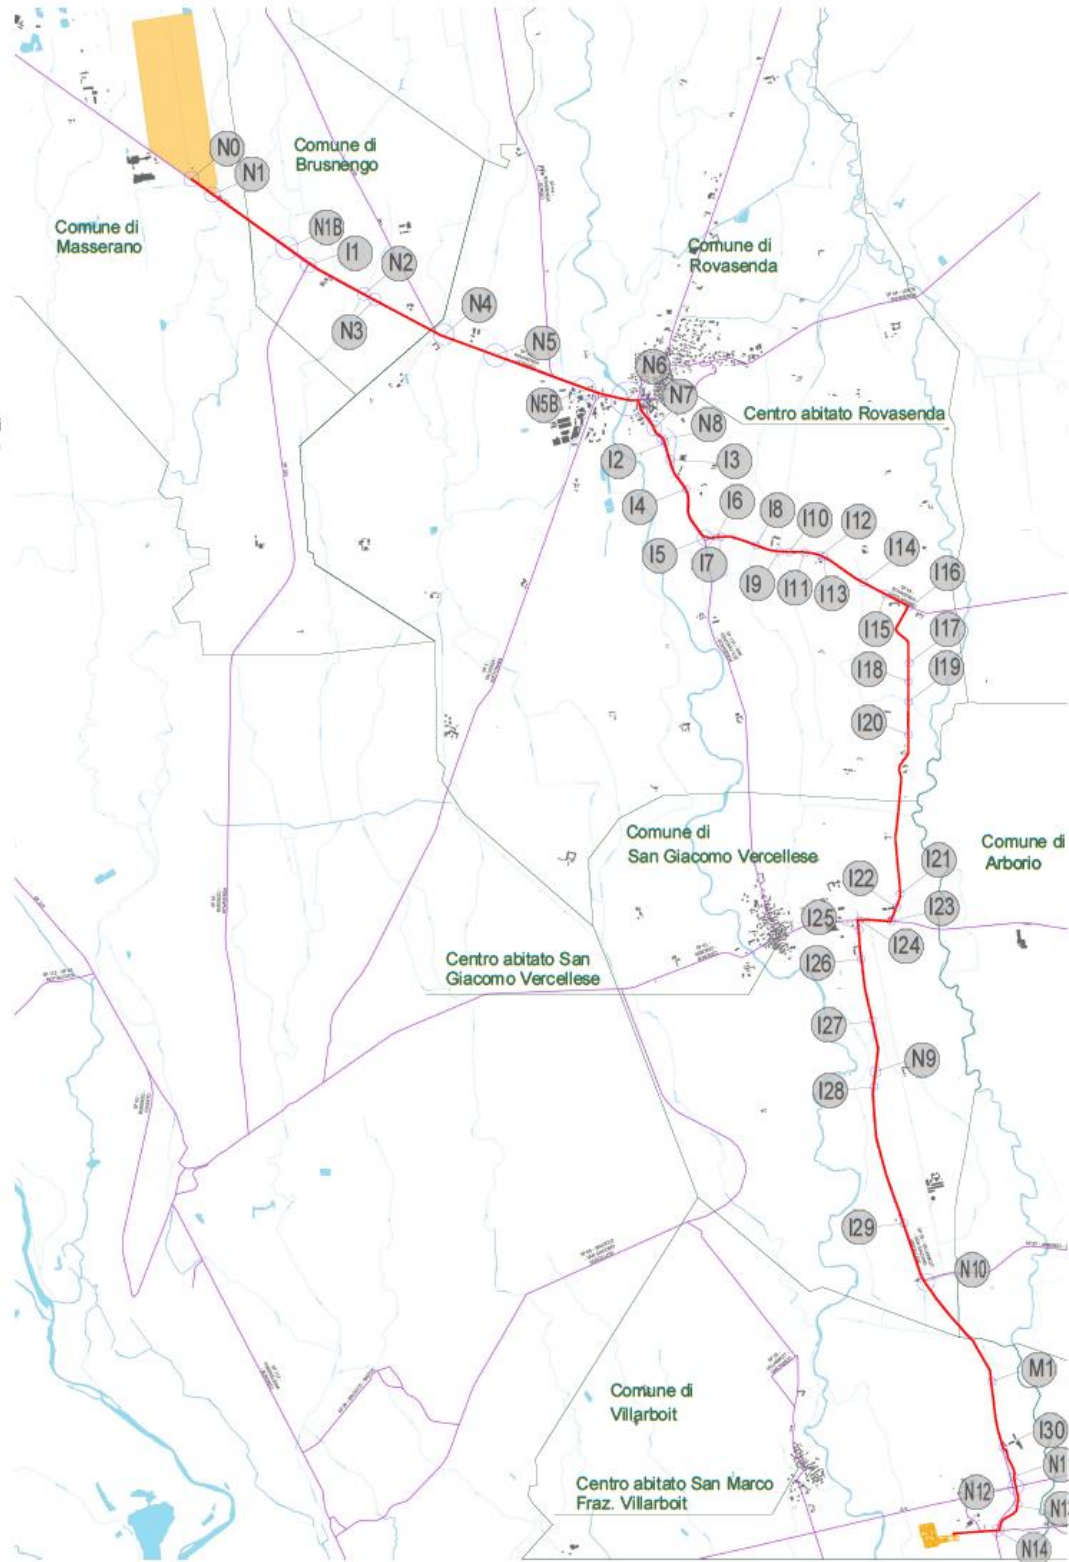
Planimetria generale linea di collegamento cavidotto con interferenze
